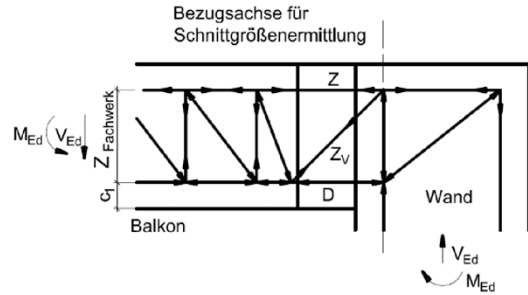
Schöck Isokorb® Typ K-O und K-O-F mit Anschluss an Wand
